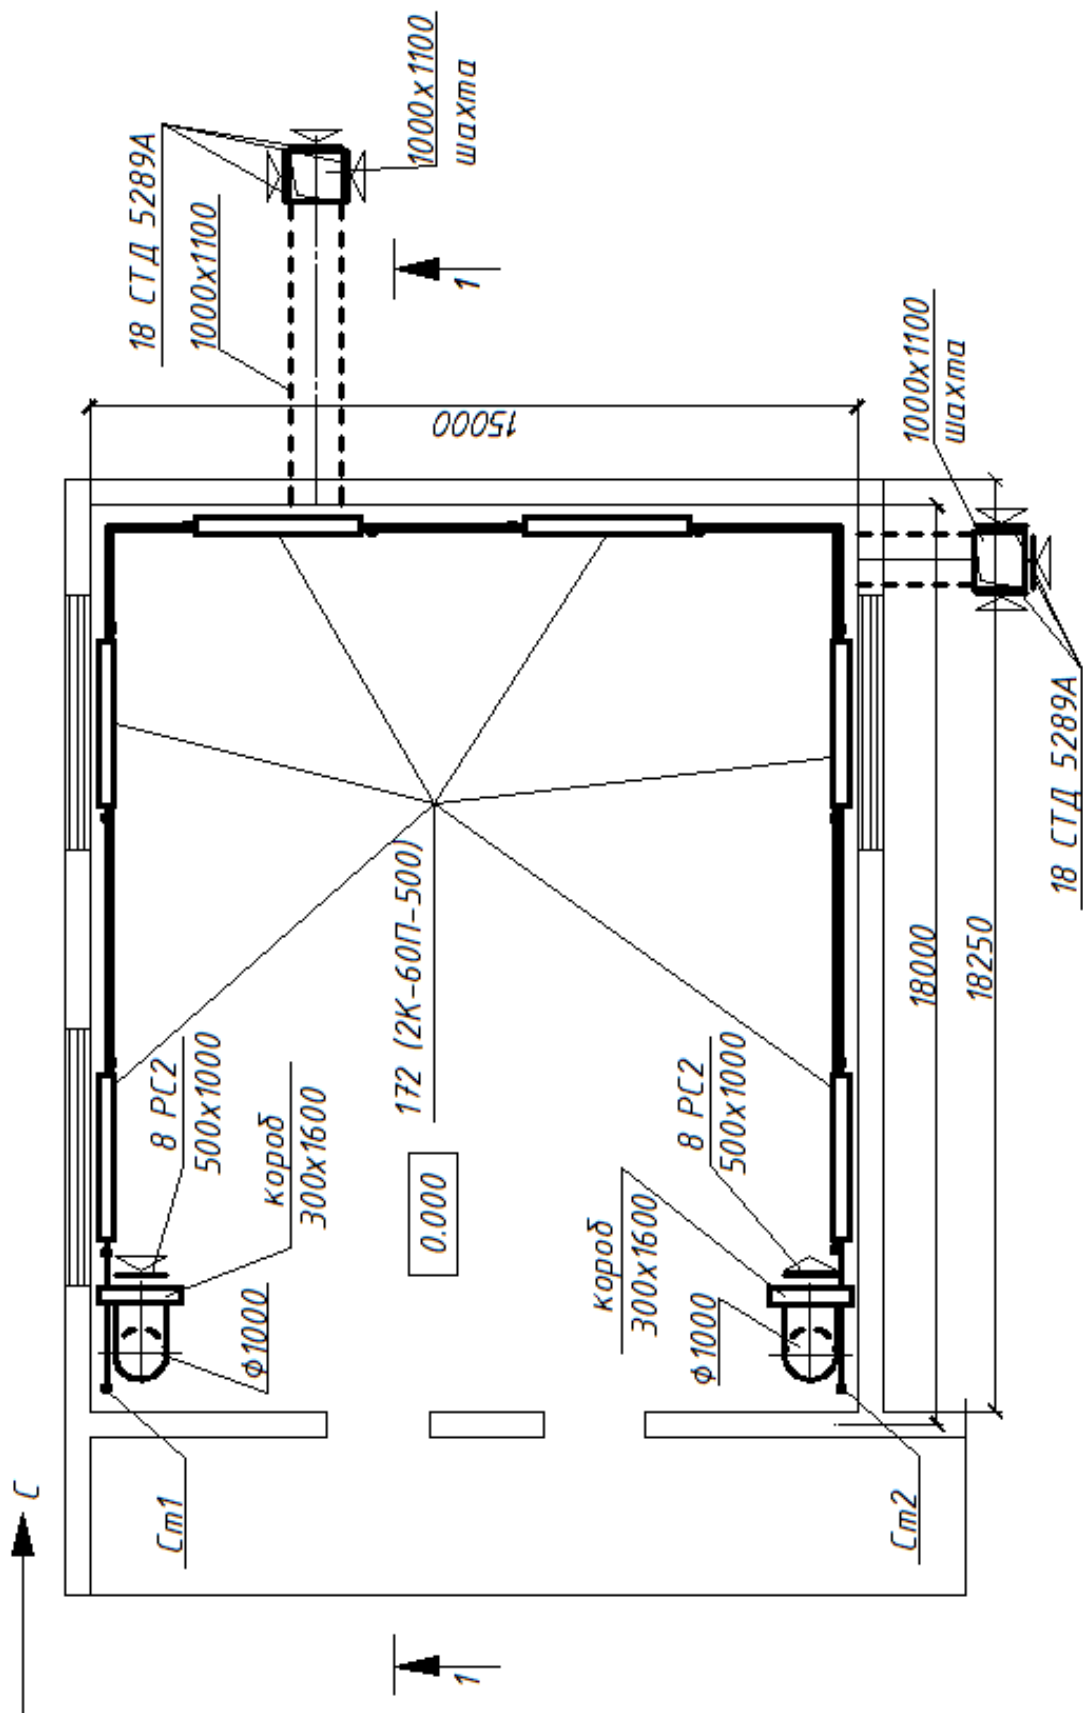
План актового зала с нанесением отопительно-вентиляционного оборудования
